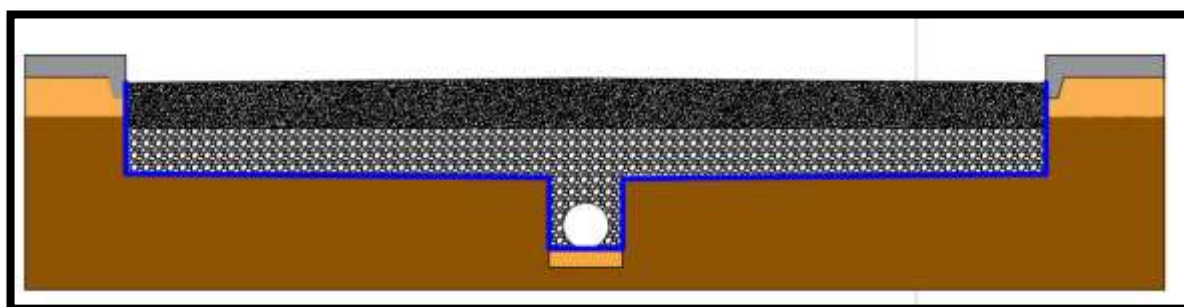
Sección transversal del pavimento permeable, con tubería para drenaje pluvial
